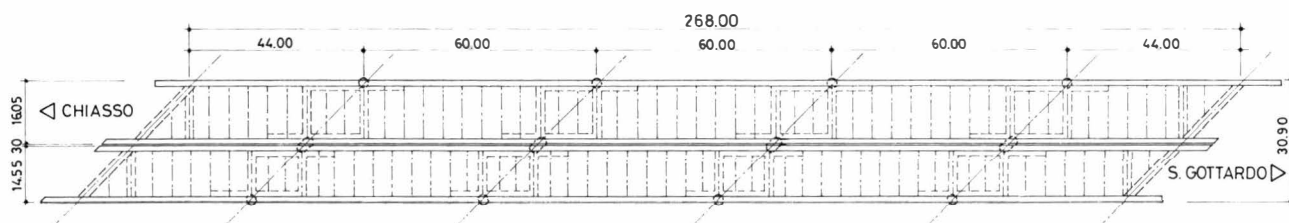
Grundriss - Plan - ground plan - Pianta
